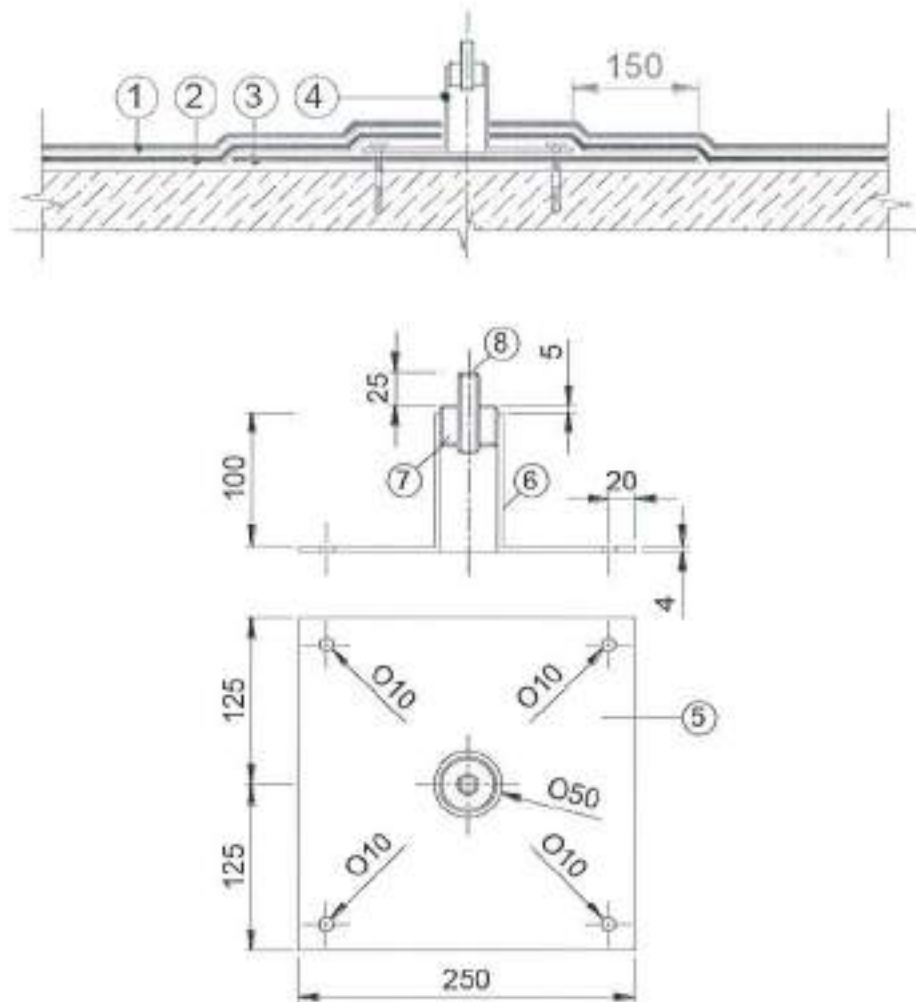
Устройство примыкания кровельного ковра к горячей трубе
